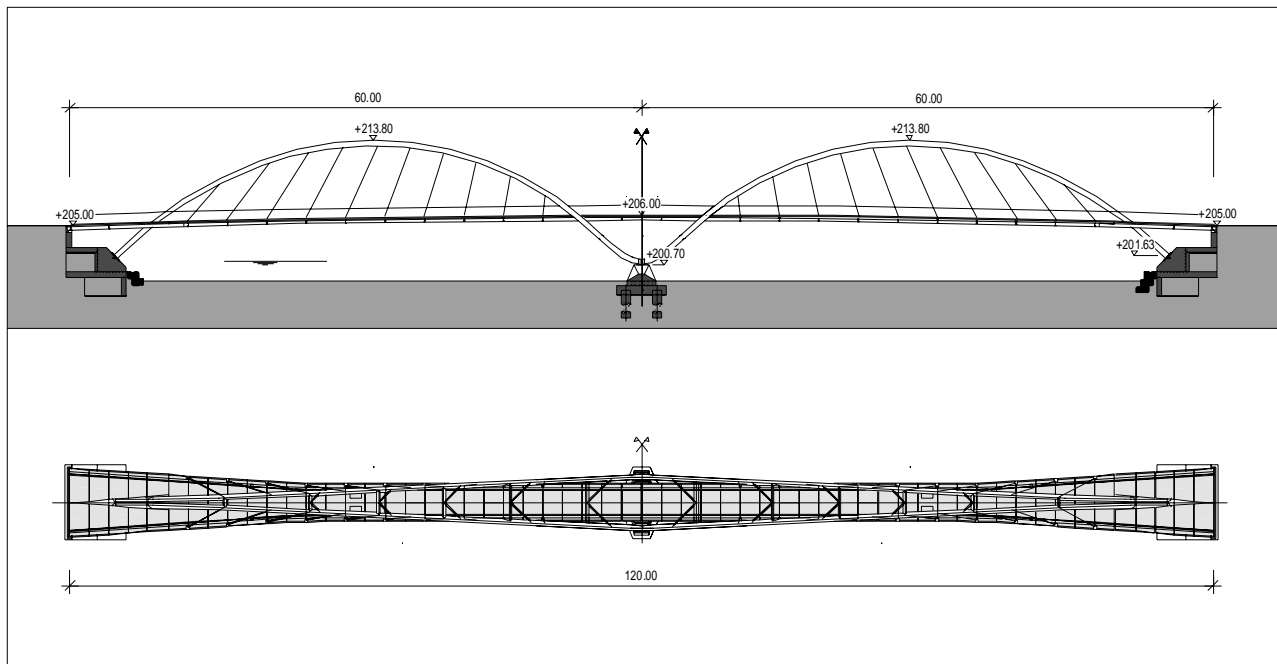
Plan d'ensemble de l'ouvrage (élévation et vue en plan)
